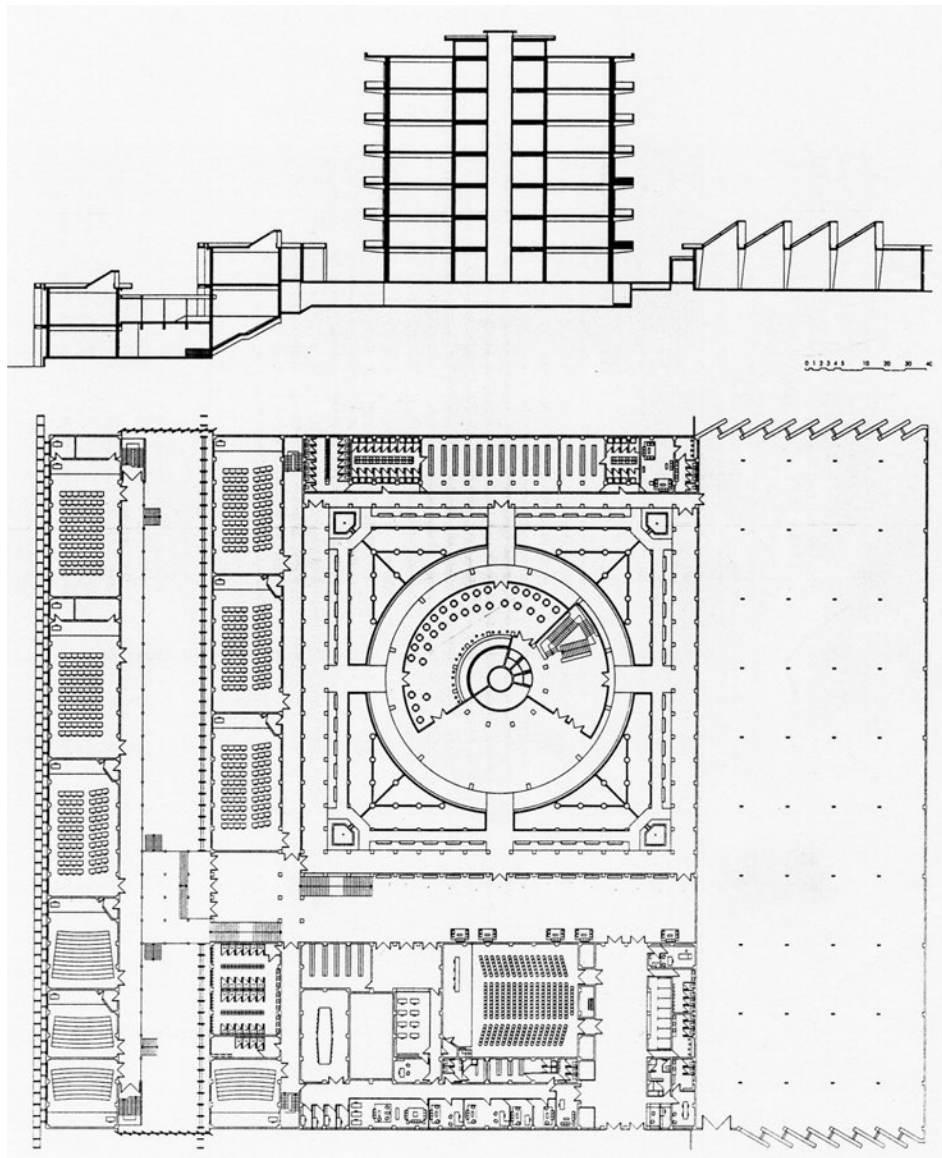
Planta general y sección transversal. Imagen: © AP-CTAV.
